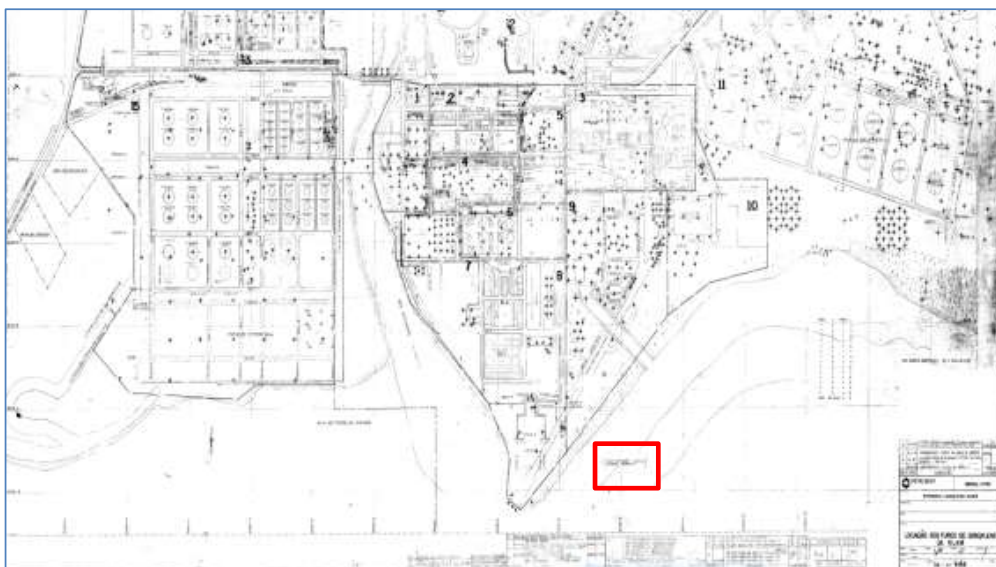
Planta de Locação dos Furos de Sondagem da RLAM, tombada sob o n° SA-V-00486
